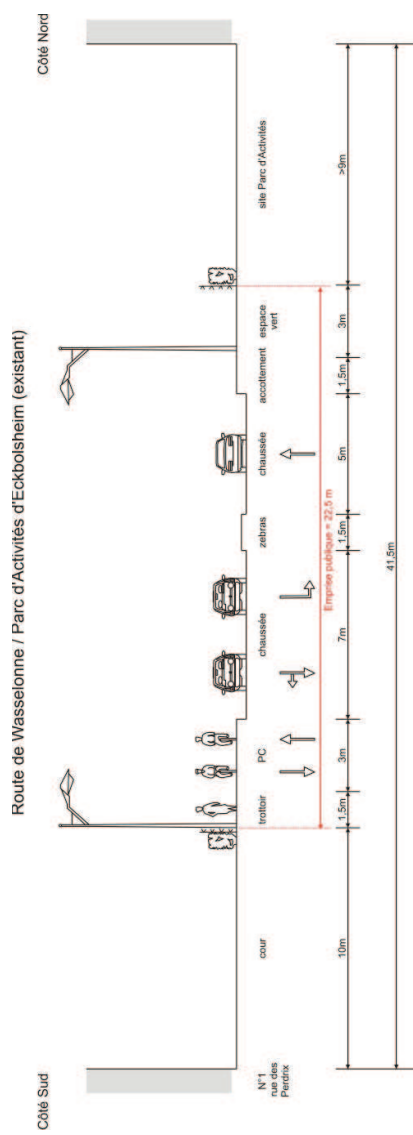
Situation initiale – coupe 18 (route de Wasselonne)
